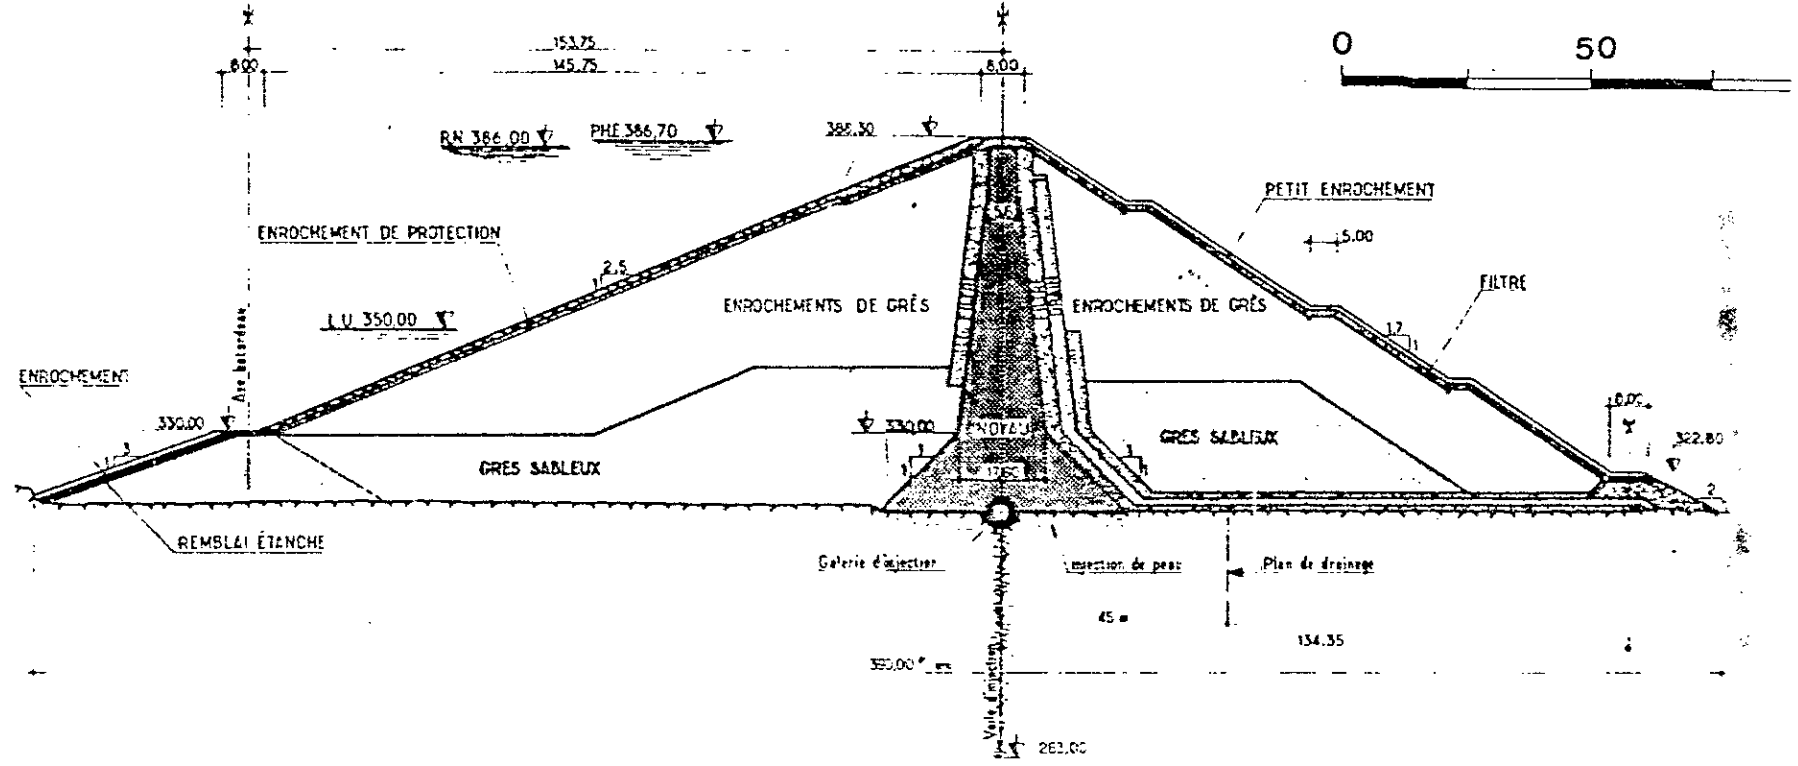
Coupe Transversale de la Section Centrale du Vieu Pré
